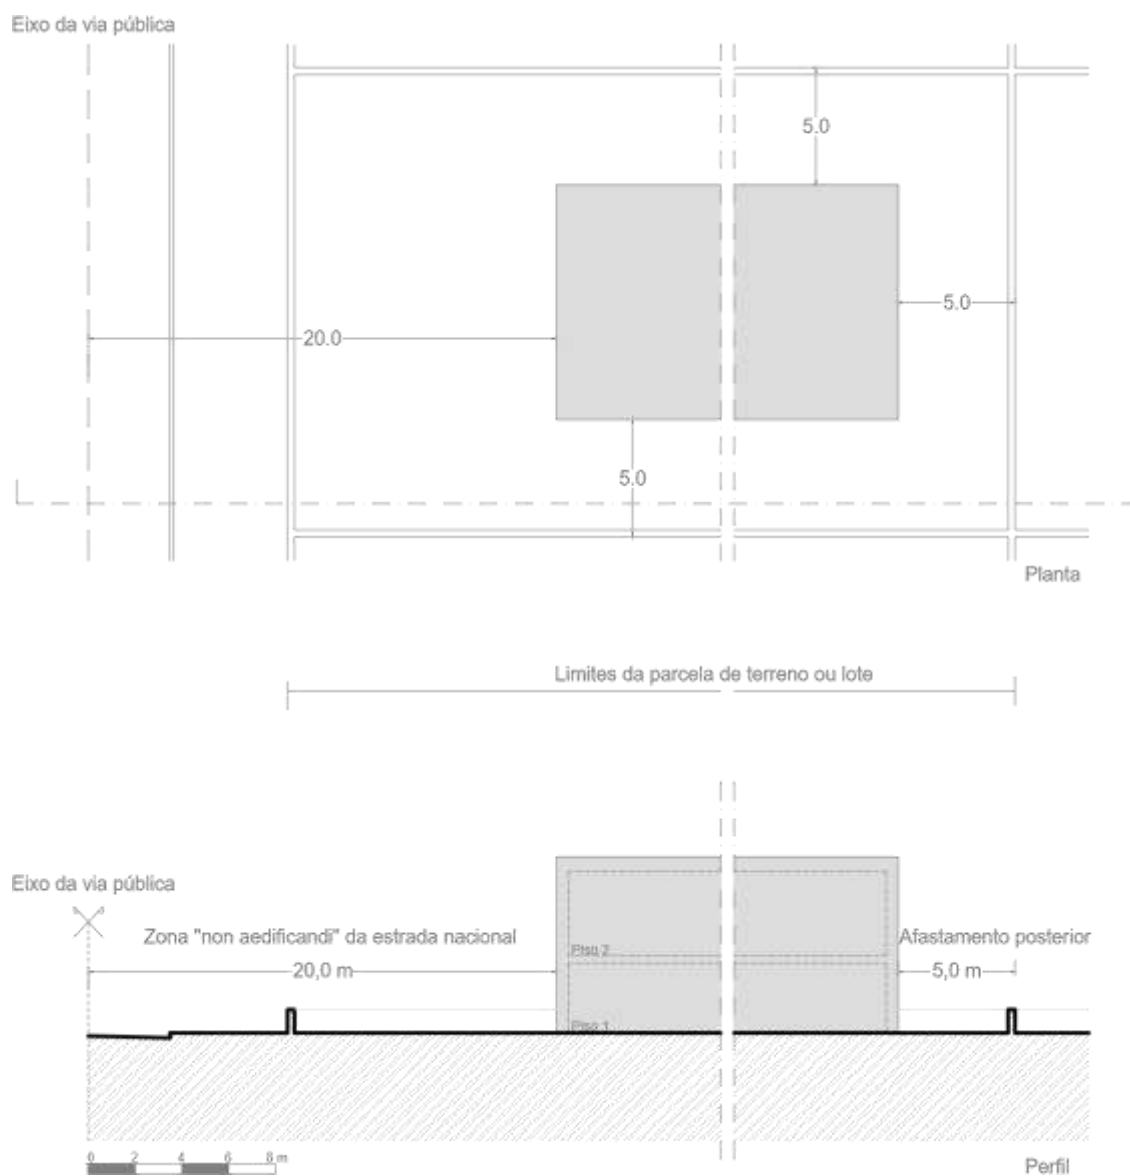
Planta e perfil transversal da estrada nacional (afastamentos)
